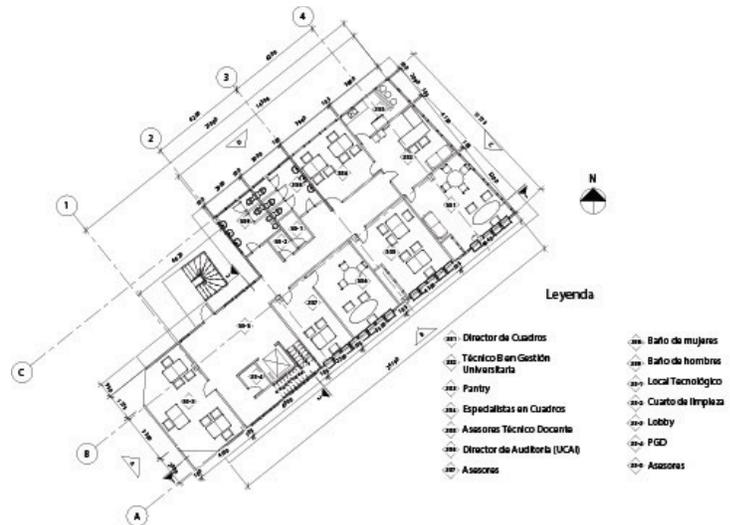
Planta del 5to nivel del edificio. Fuente: Autores.
